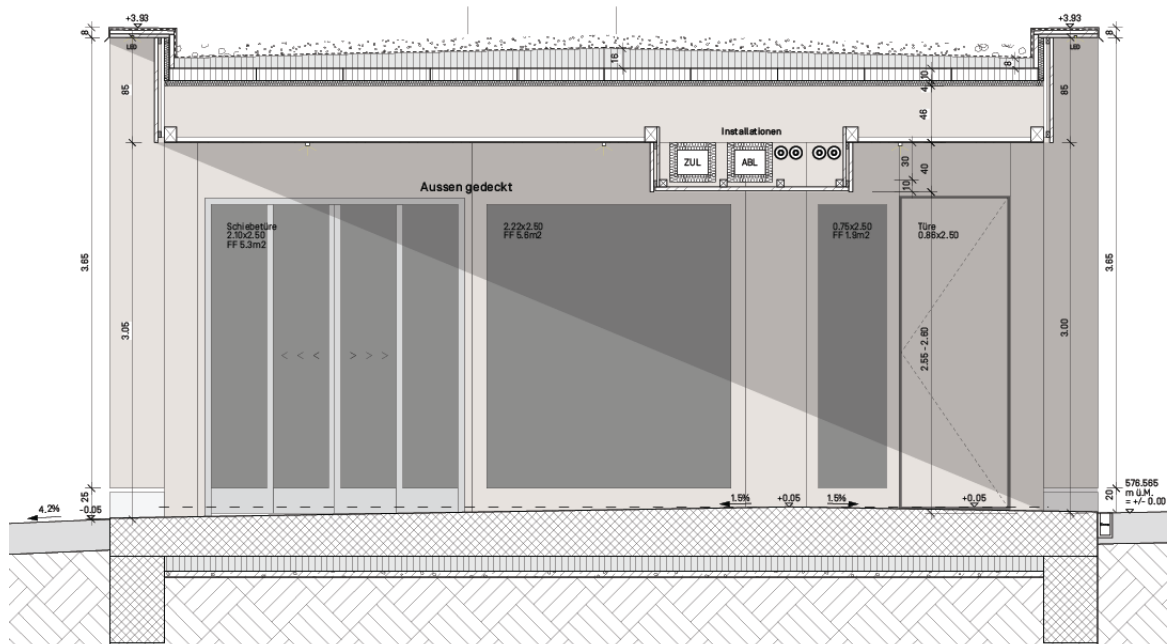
Querschnitt Aufnahmegebäude, Dimension X AG
